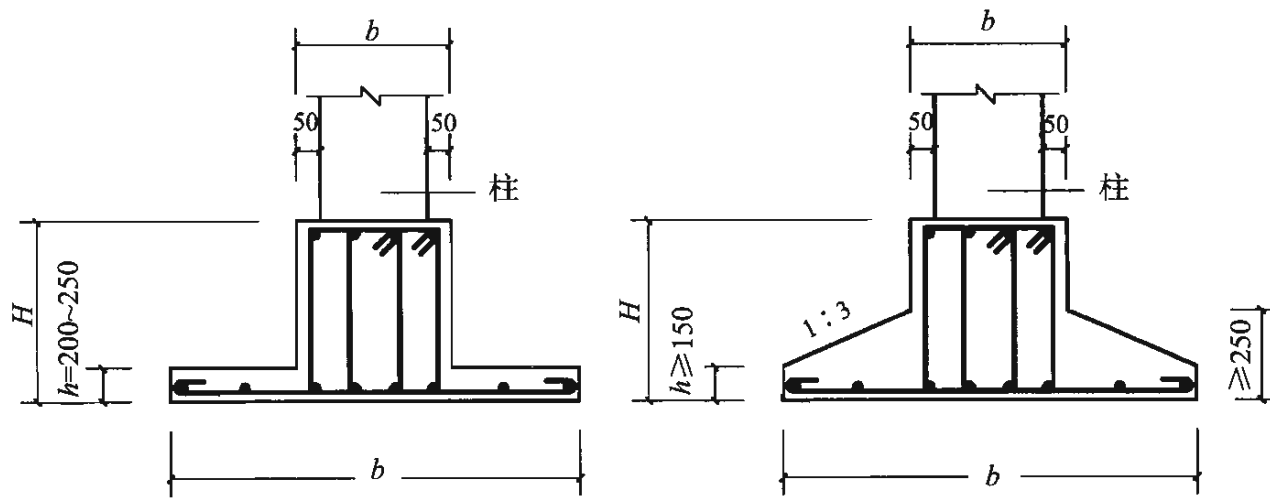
柱下钢筋混凝土条形基础配筋构造示意图
